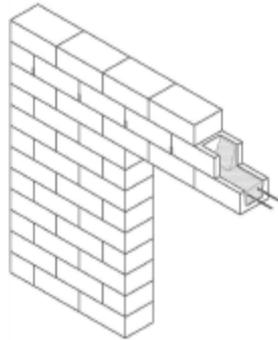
formazione dell’architrave di porta con blocco a canaletta riempito in calcestruzzo armato
